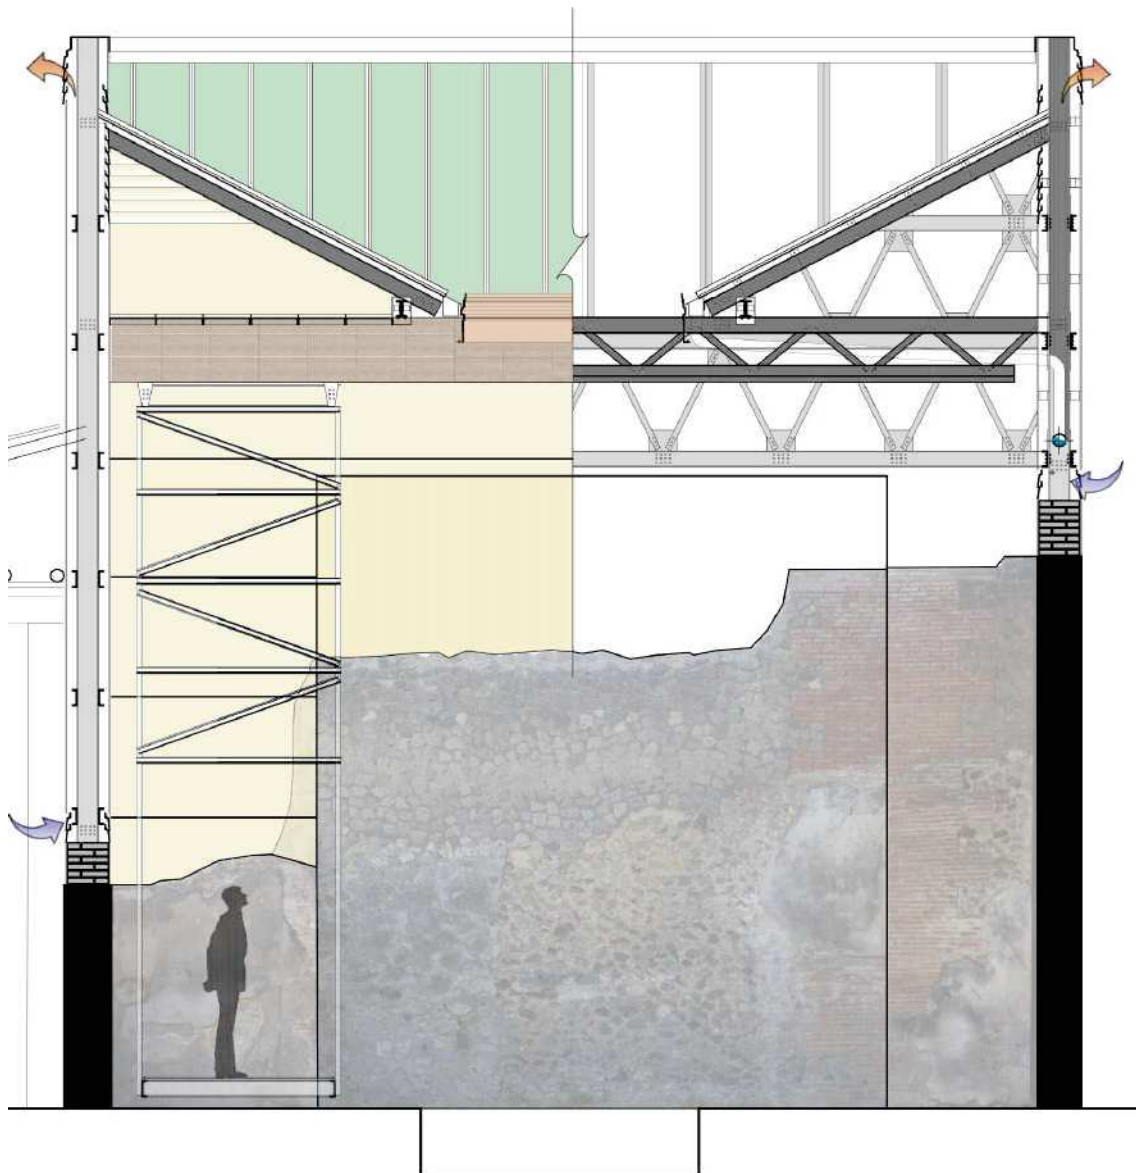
Sezione trasversale dell'atrio *b* con l'intervento di copertura
